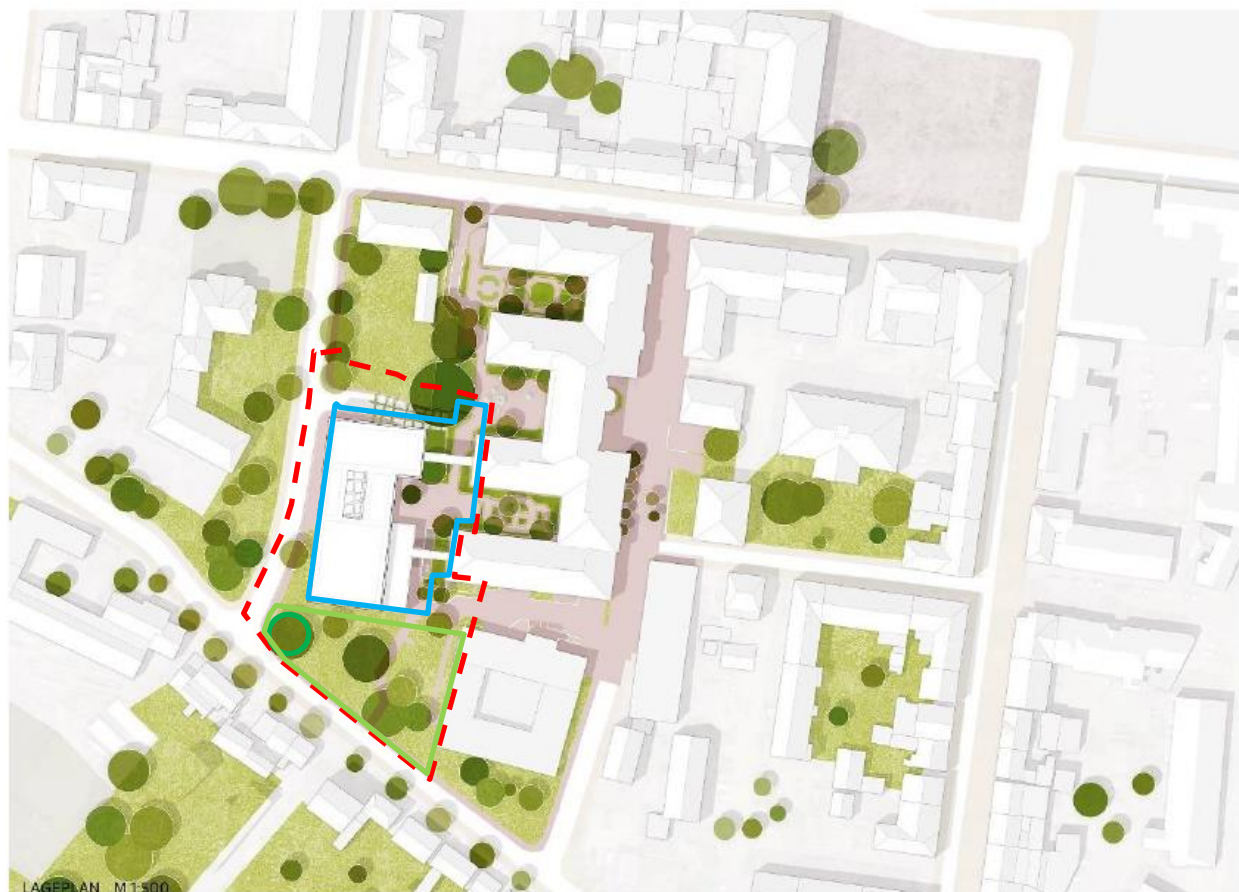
Lageplan Erweiterung Kreishaus Ratzeburg (ppp Architekten 2022).
